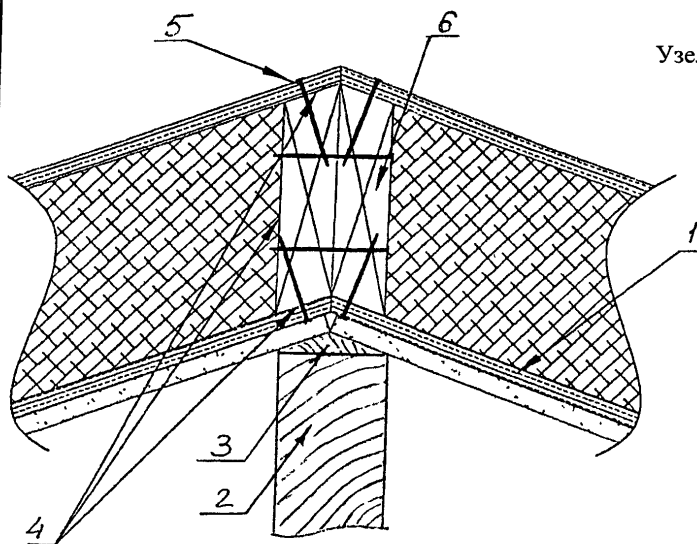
Примеры крепления панелей покрытия (перекрытия) к
